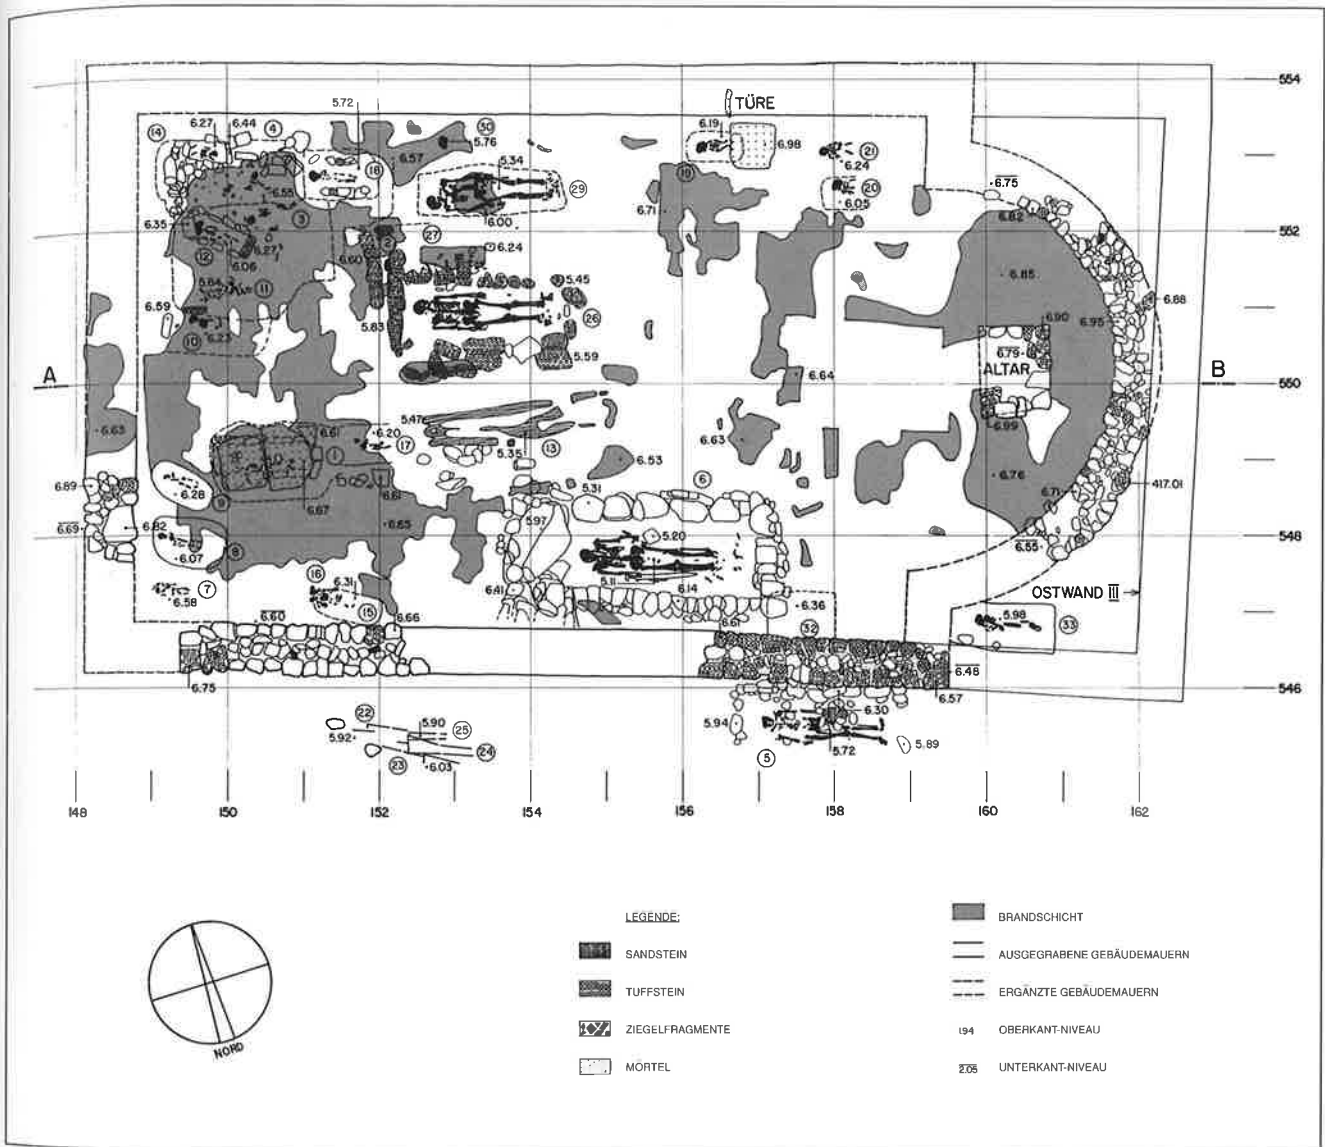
Stein am Rhein. Kirche Burg. Grundriss der Bauphase II.2 mit Gräbern und Ausdehnung der Brandschicht. M 1:100.
